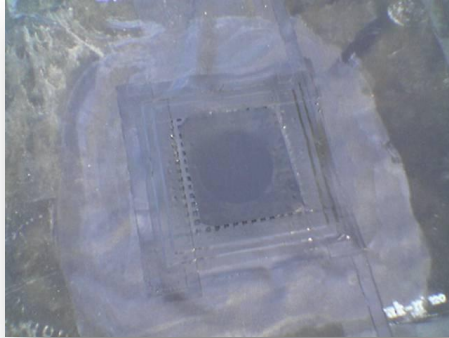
Detalle de sumidero tapado para prueba de estanqueidad
